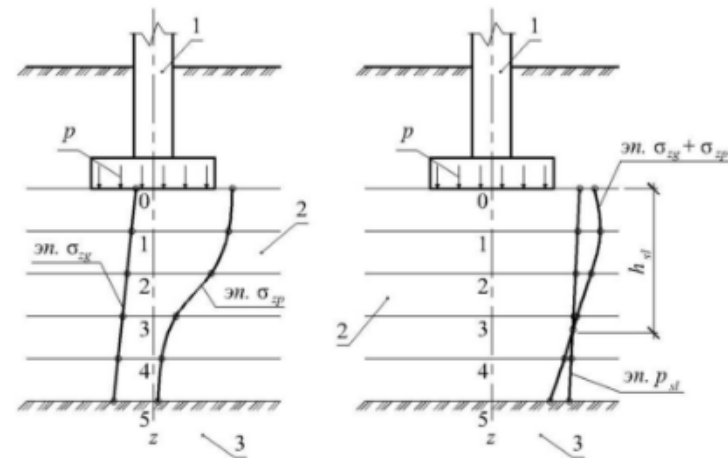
Схемы к расчету просадок в основании фундаментов:
